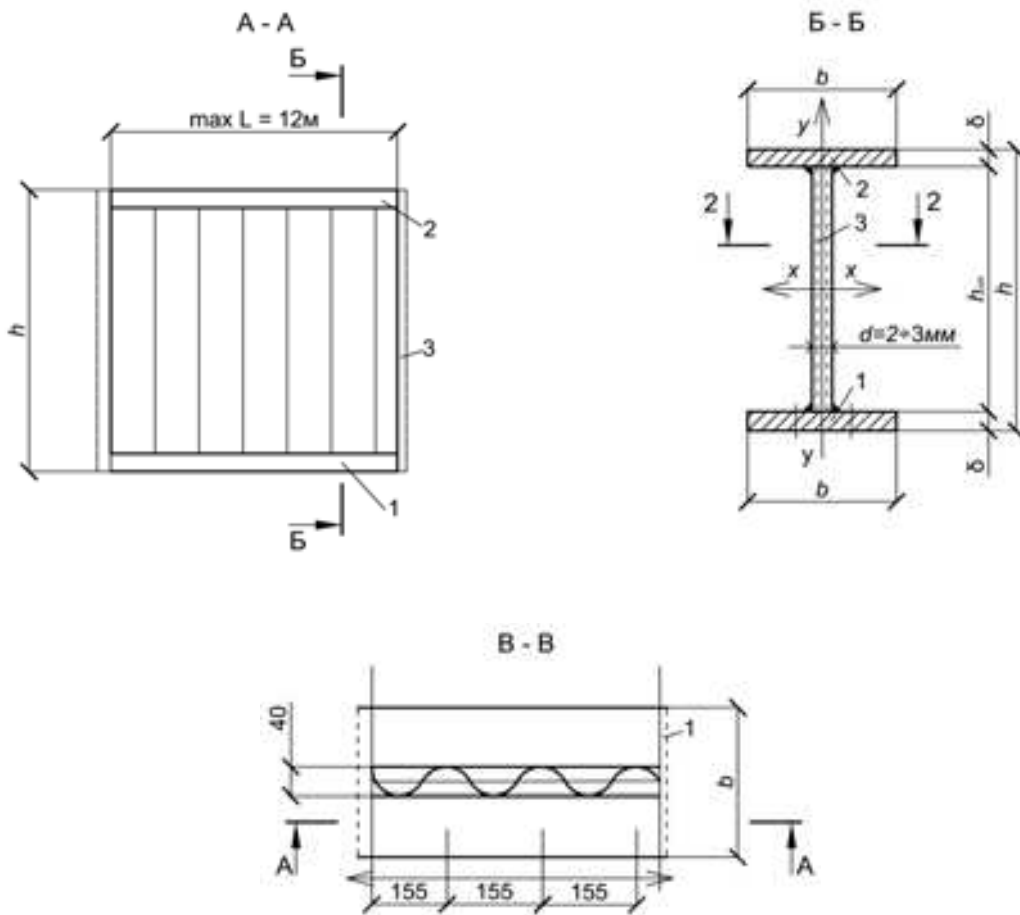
Схема стальной балки с гофрированной стенкой: сечение А-А – продольный разрез; сечение Б-Б – поперечный разрез; сечение В-В – план стальной балки (без огнезащиты): 1 – растянутая полка; 2 – сжатая полка; 3 – гофрированная стенка;  $h$  и  $b$  – высота и ширина сварного двутавра стальной балки;  $d$  – толщина гофрированной стенки, мм;  $\delta$  – толщина полки стальной балки, мм
